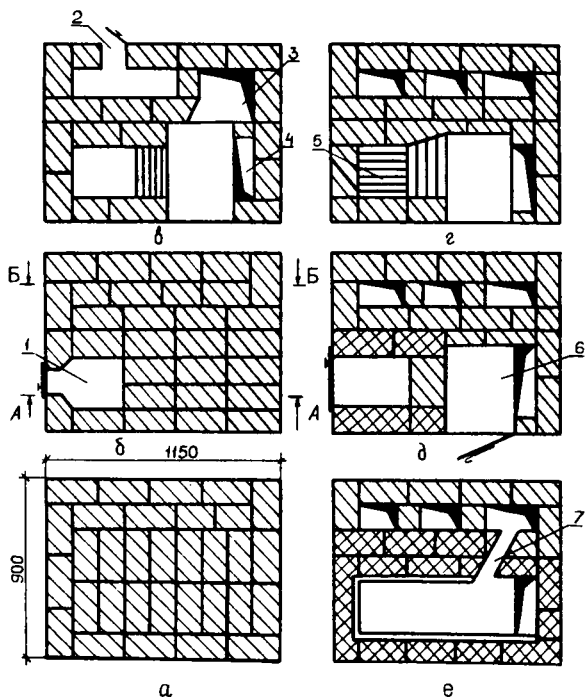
Кладка печи № 6 с 1-го по 11-й ряд: а — 1—3-й ряды; б — 4—5-й ряды; в — 6-й ряд; г — 7-й ряд; д — 8—10-й ряды; е — 11-й ряд; 1 — зольник; 2 — окно чистки; 3 — первый жаровой канал; 4 — опускной канал под духовку; 5 — колосники; 6 — духовка; 7 — подсосный канал
